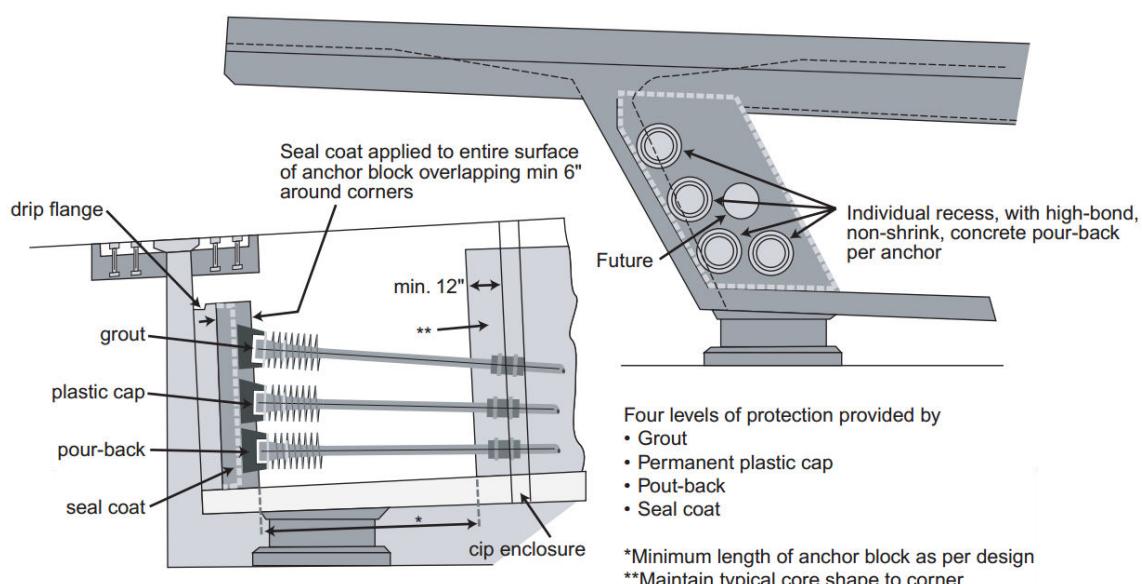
Protección de anclajes individuales en juntas de expansión.
